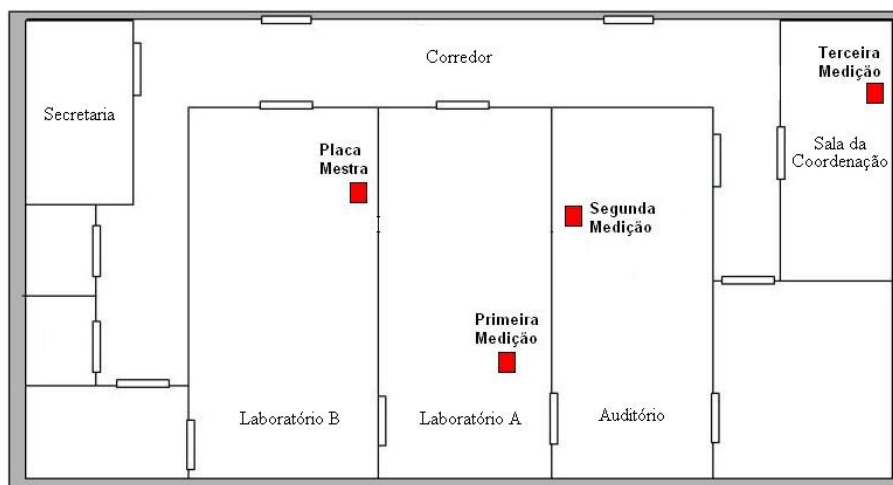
Localização dos pontos de medição na planta baixa do LAMP.
